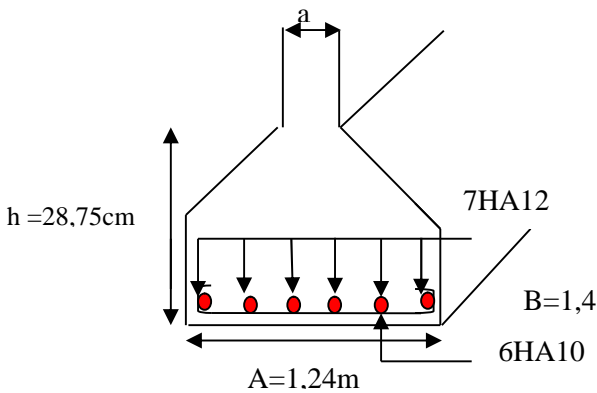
la coupe de ferraillage de la semelle isolé
